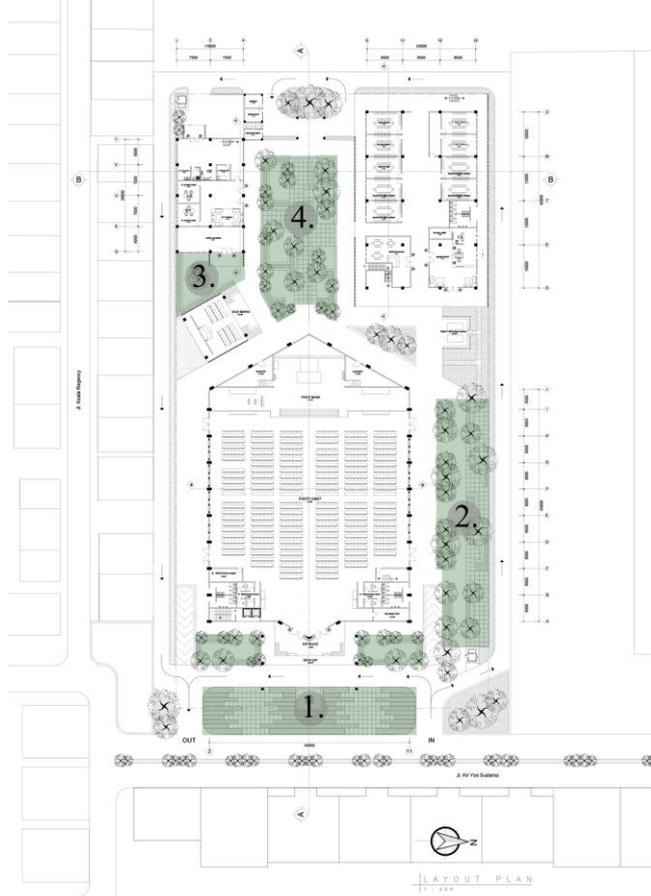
menunjukkan penataan Zonning dan pencapaian bangunan:
